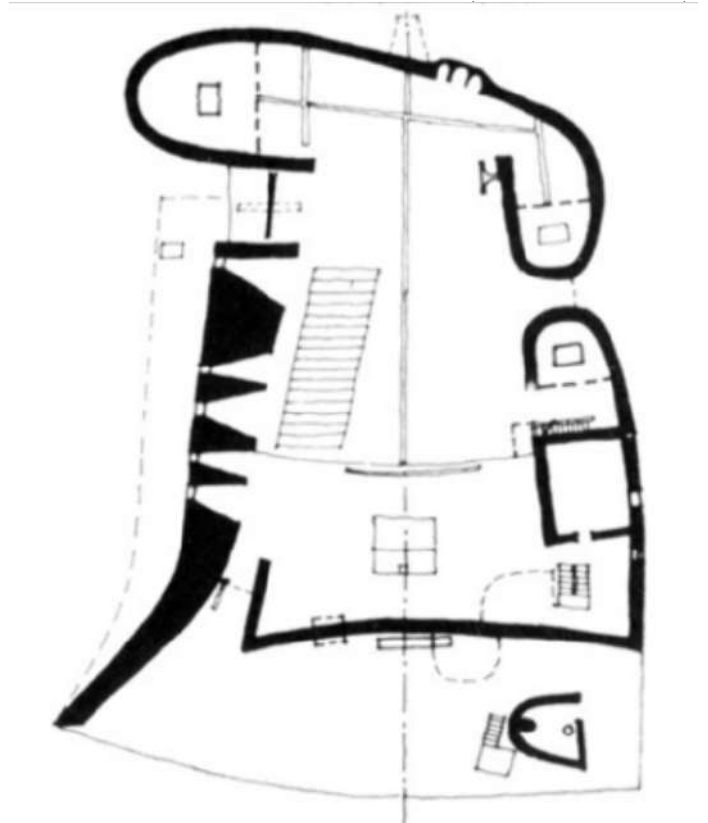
Planta Baixa da Capela Notre Dame du Haut. Fonte: Architectuul.
